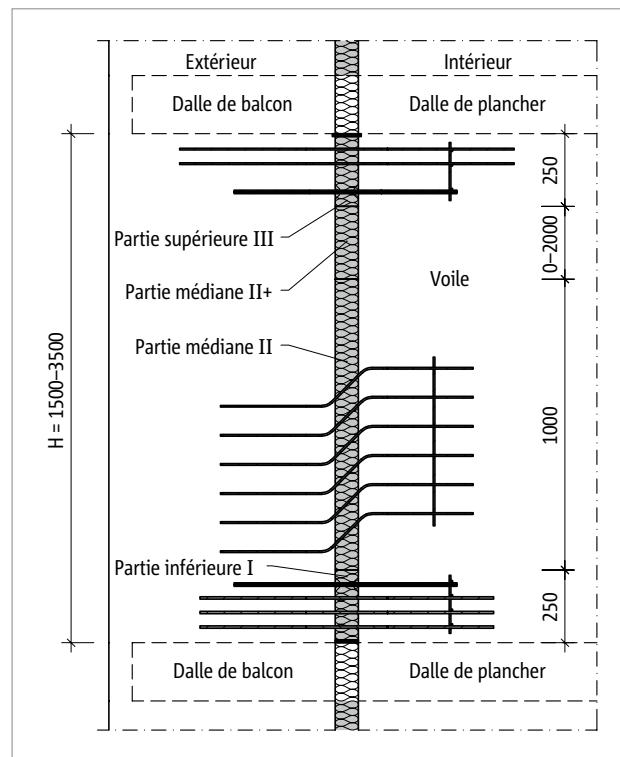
Schöck Isokorb® T Type W : Construction de balcon avec murs de refend porteurs isolés thermiquement
